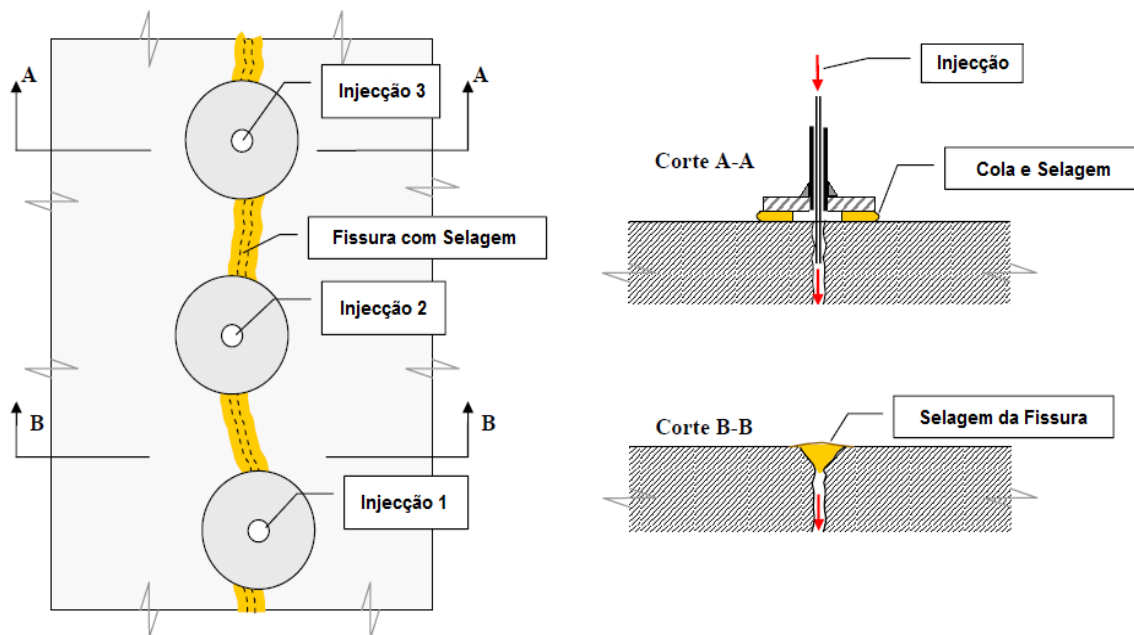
Injecção com injectores de superfície (adaptado de [32])
